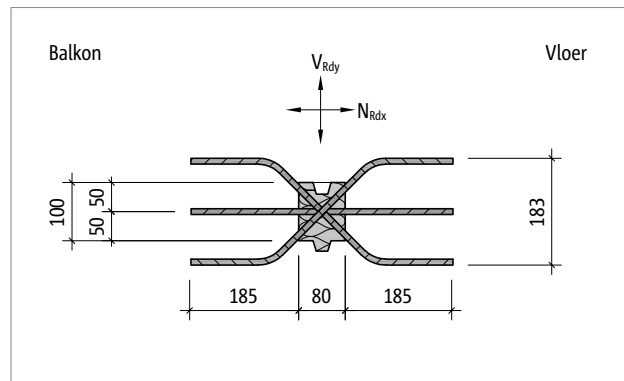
Schöck Isokorf® T type H-NN2: Zijaanzicht
